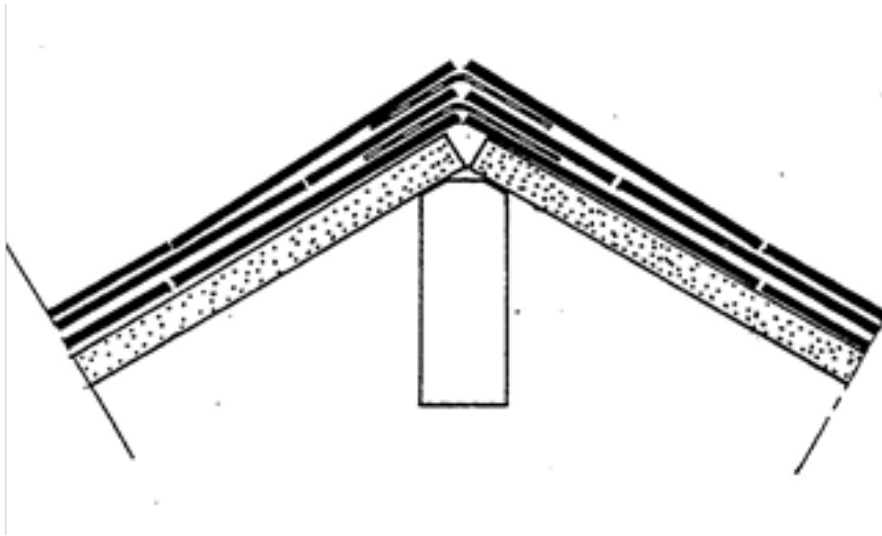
C: Nokaansluiting aan plat dak (gesloten ondergrond)
